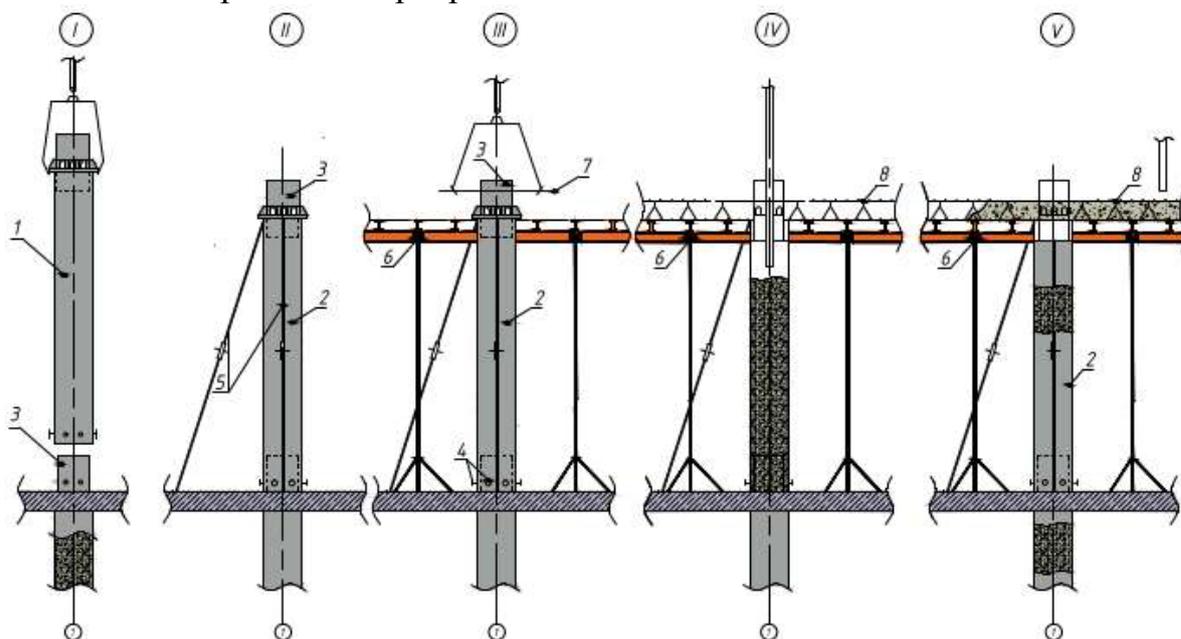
Схема возведения несущих конструкций каркаса здания с колоннами из трубобетона
